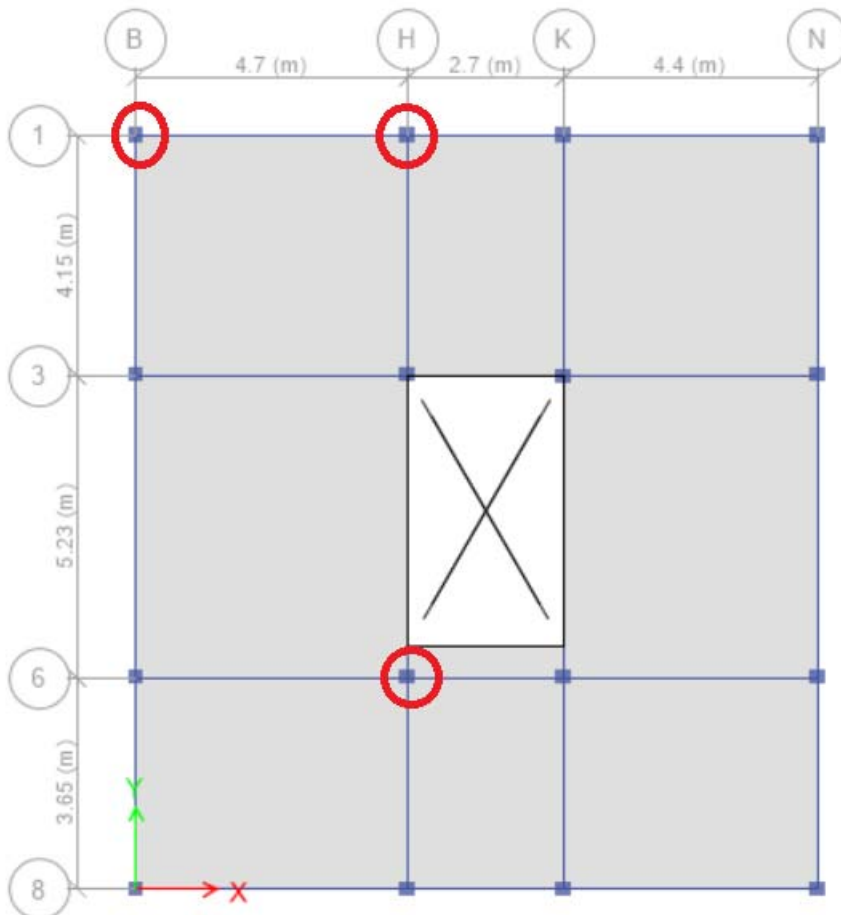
Planta de primer nivel indicando las columnas a ser estudiadas
